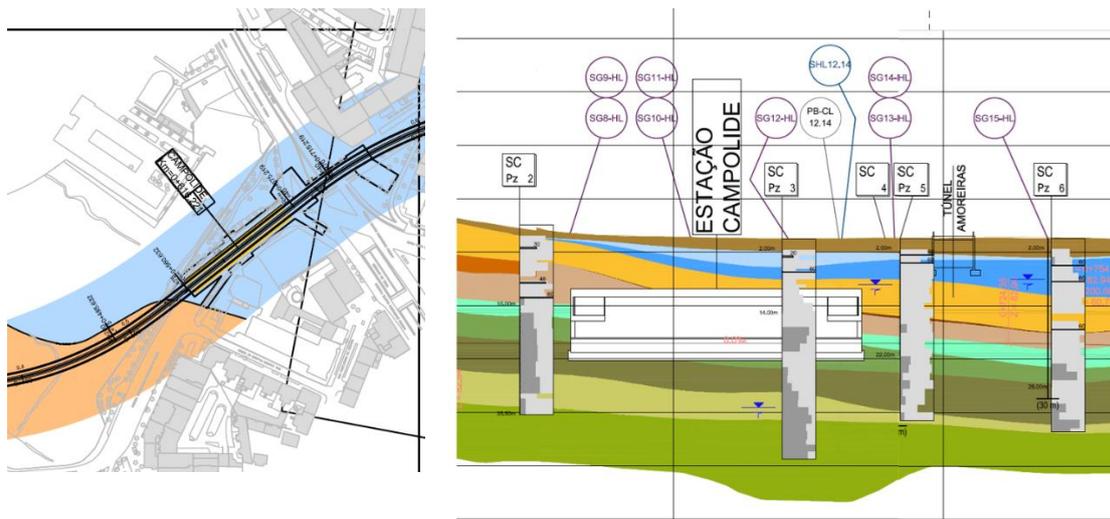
Planta e perfil longitudinal – Geologia / Geotecnia
